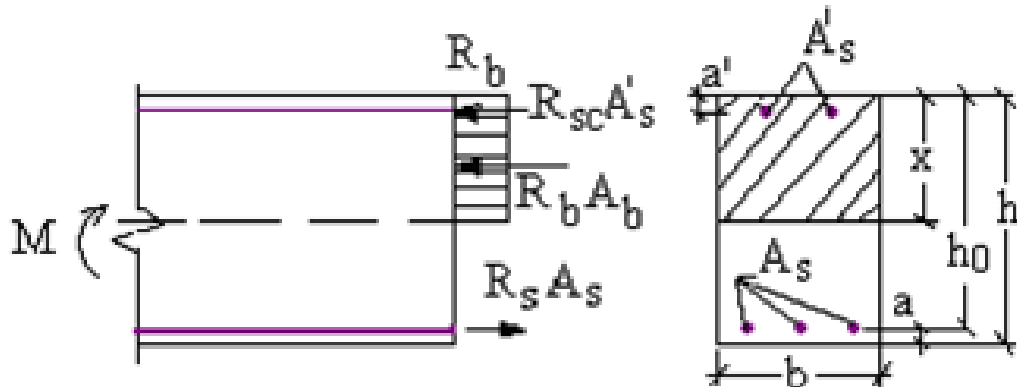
Розрахункова схема прямокутного перерізу із подвійним армуванням
